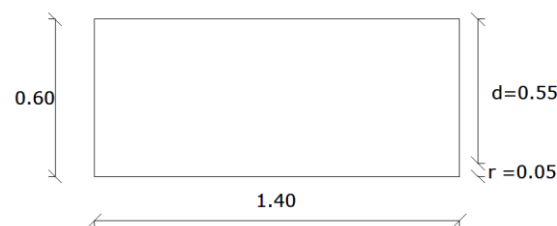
51 Geometría de la viga de asiento sección transversal.
